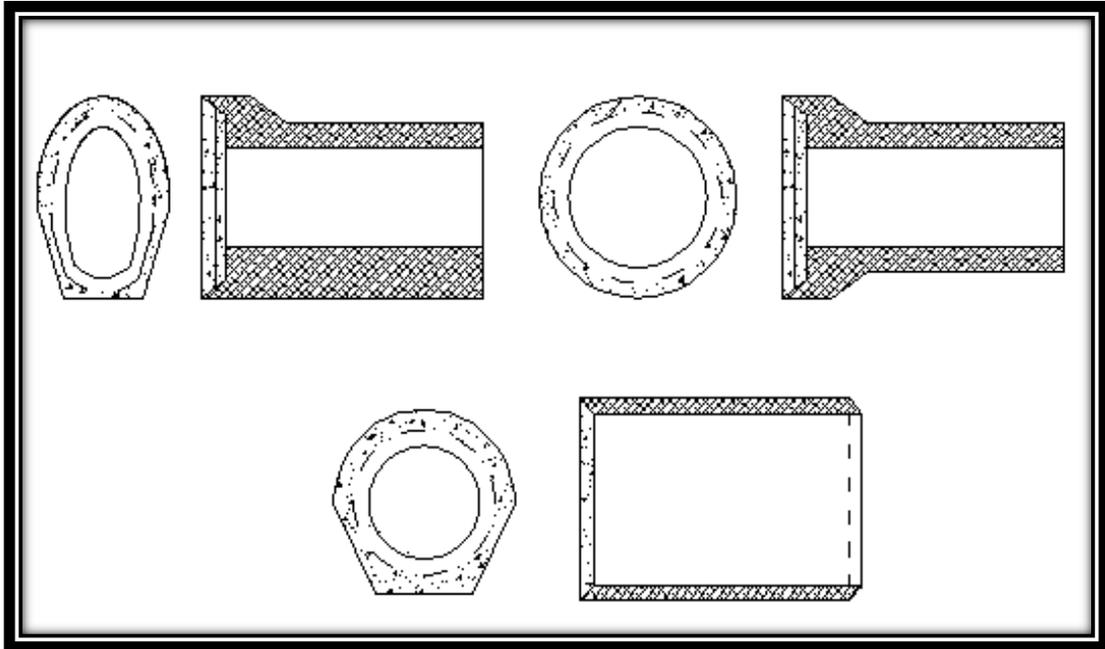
Secciones longitudinales y transversales de las tuberías más utilizadas en los sistemas de alcantarillado.
